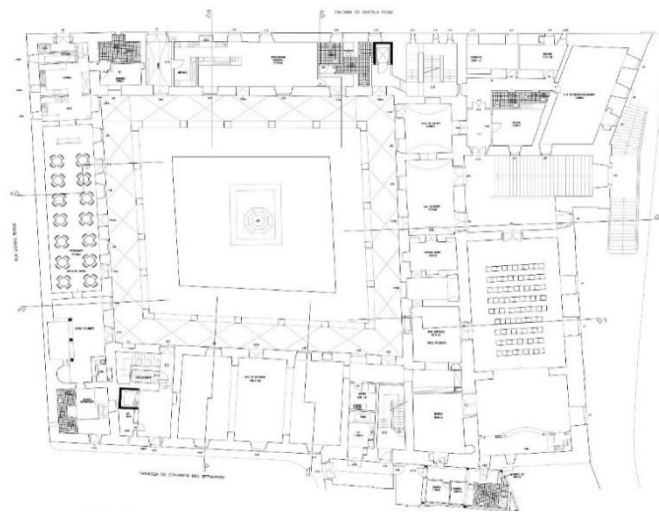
Planta arquitectónica, del Convento de las Bernardas. Lisboa.
